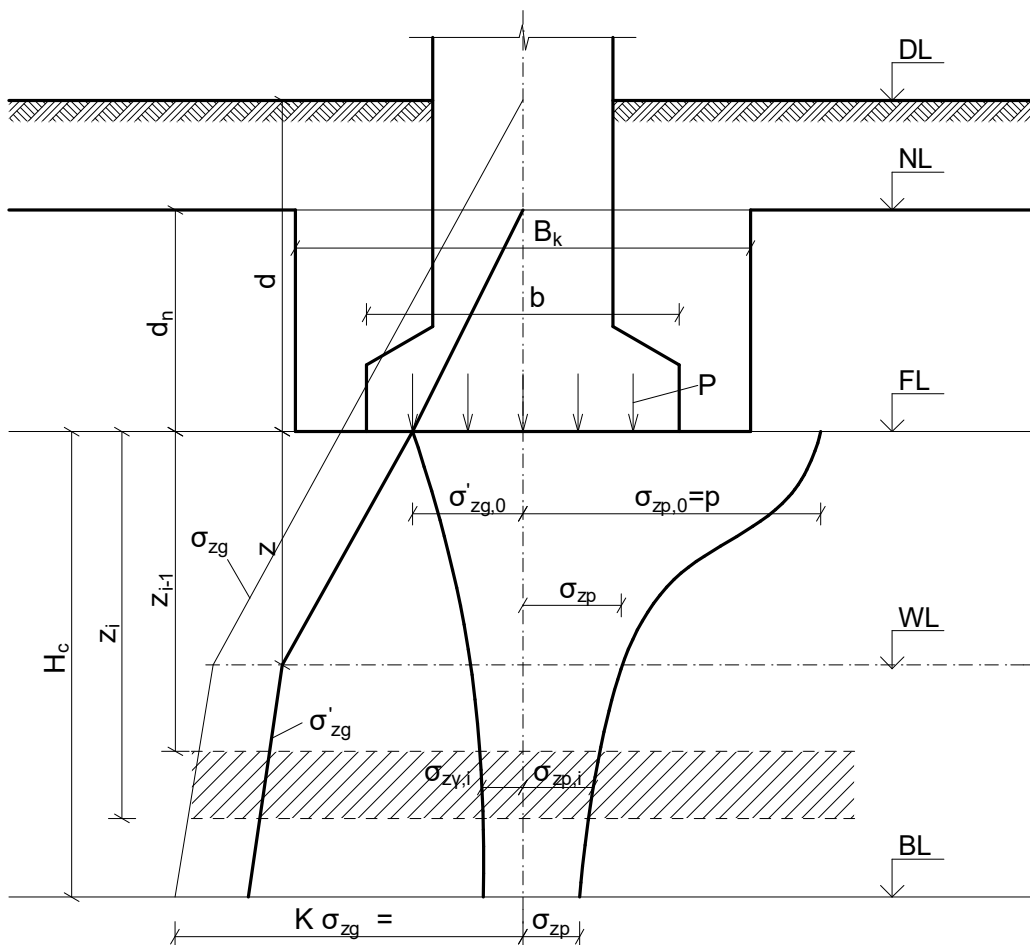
Епюри напружень під підшовою фундаменту за методом пошарового підсумовування
